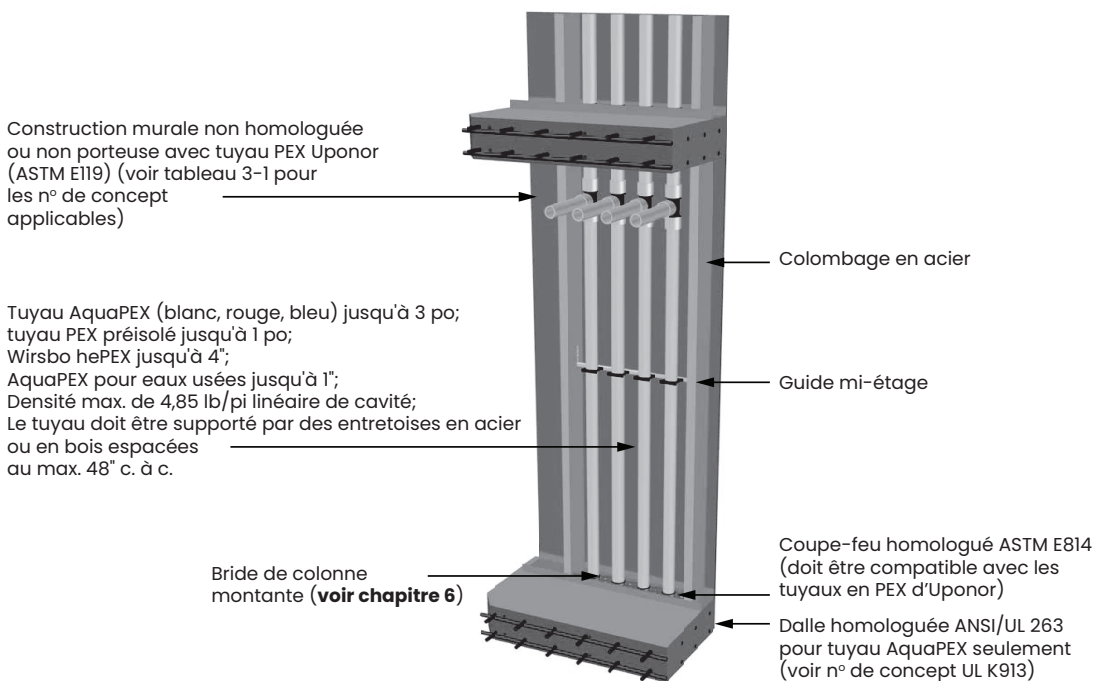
Détails pour constructions en béton (E.-U.)
